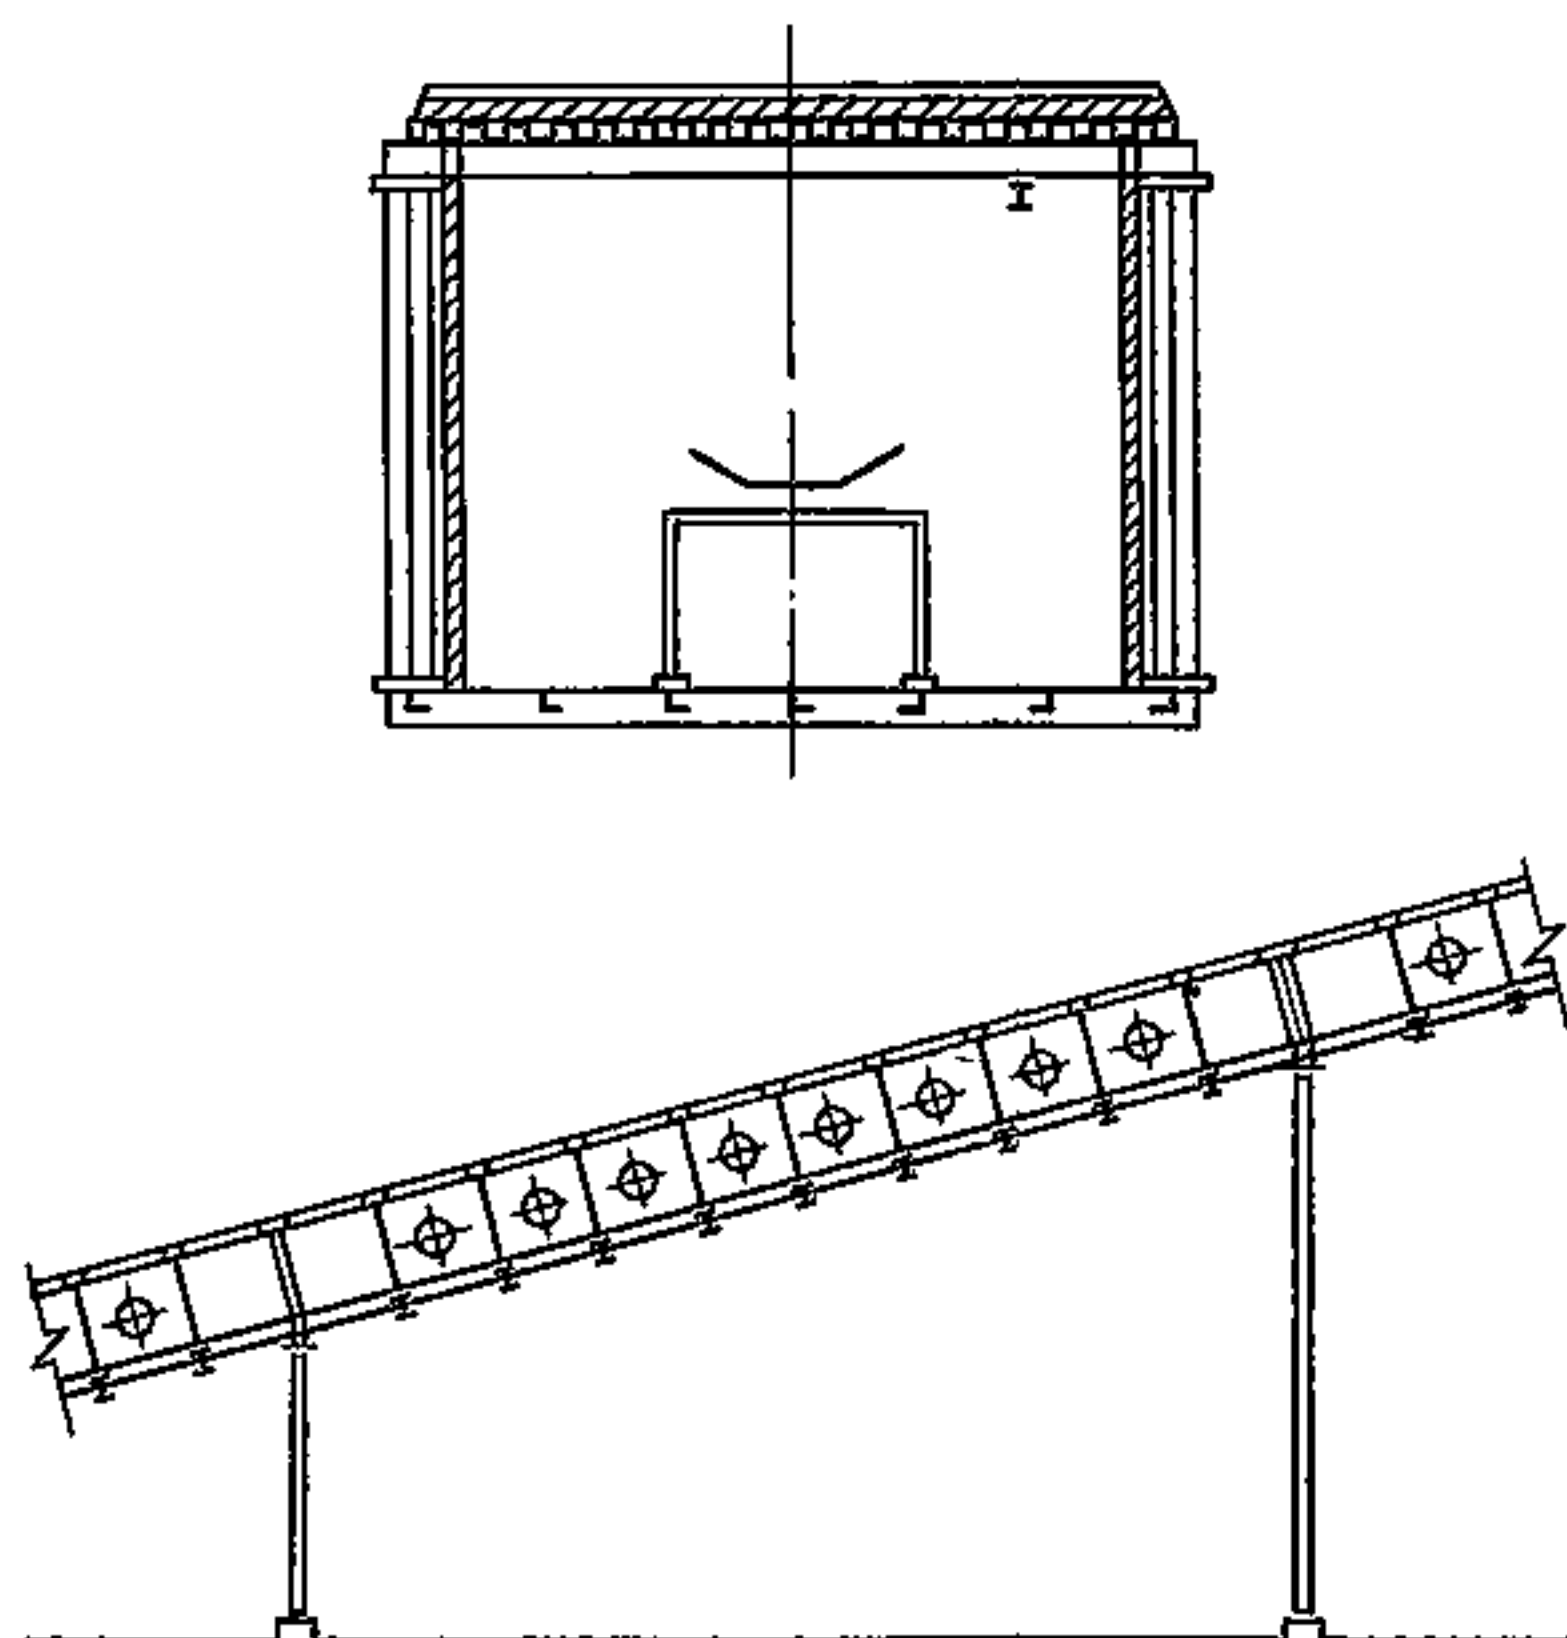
Пролетное строение конвейерной галереи с несущими конструкциями из сварных двутавровых балок
